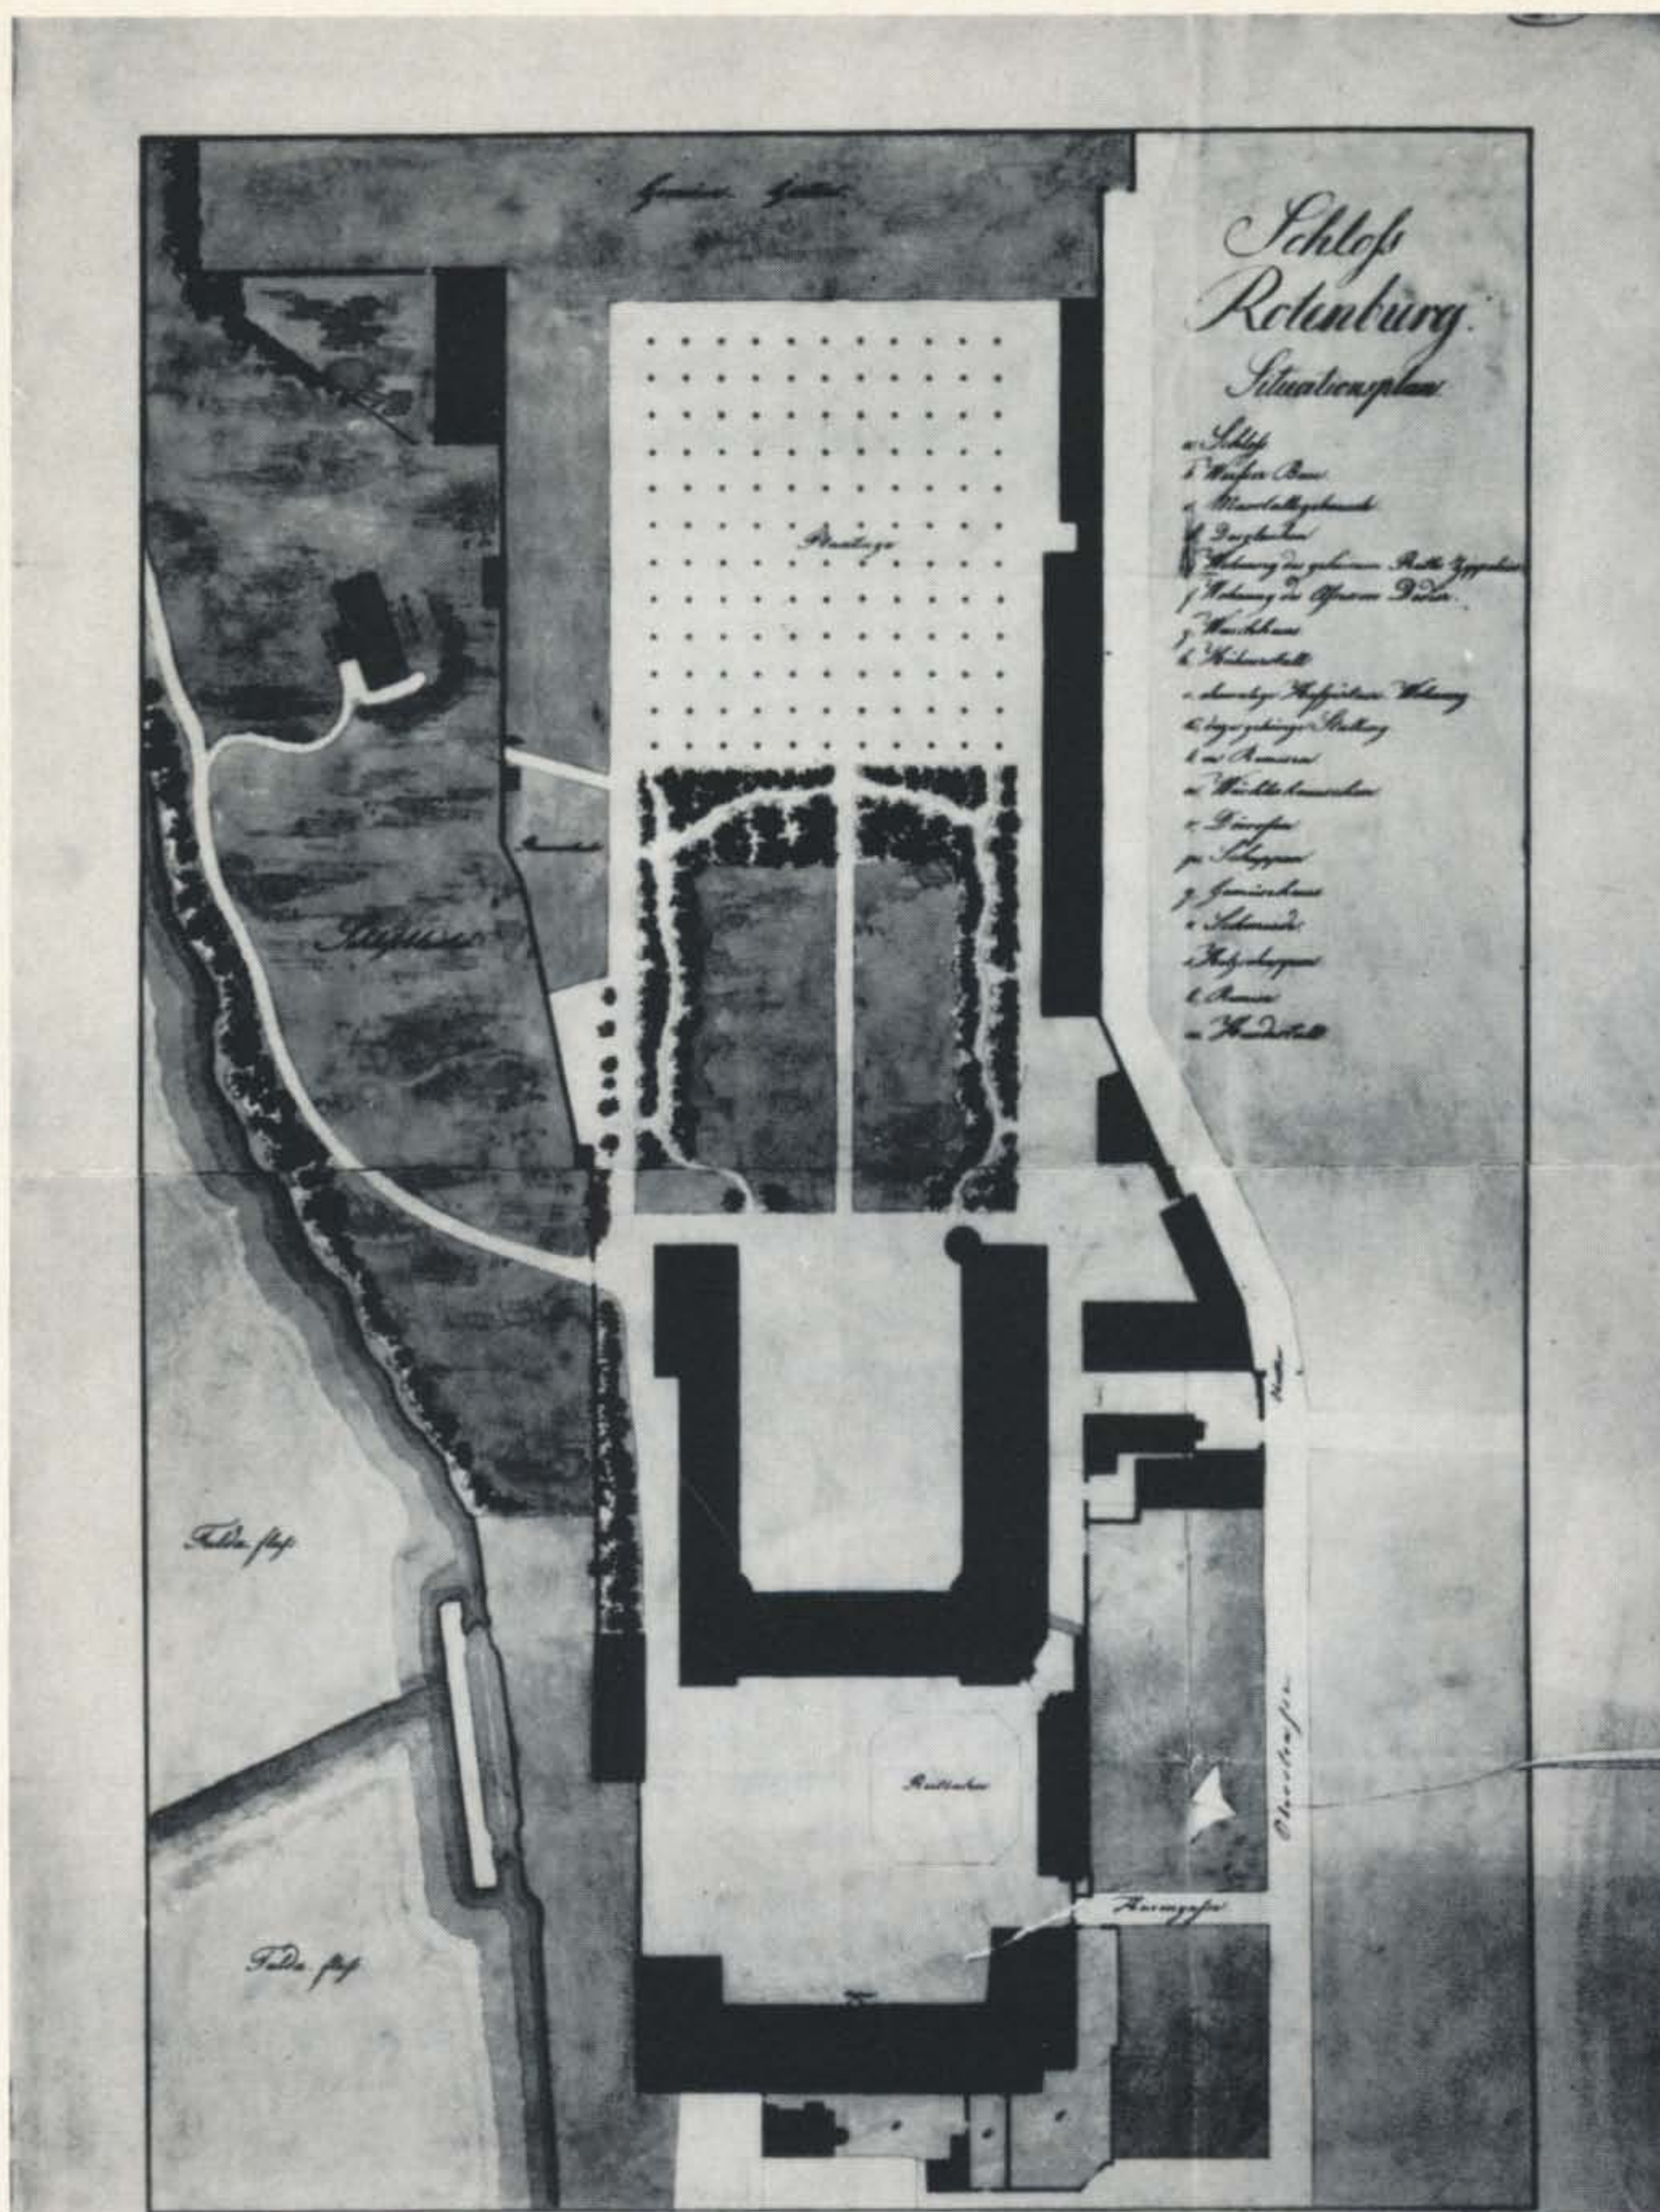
Lageplan des Schlosses und Schloßparks mit Nebengebäuden
